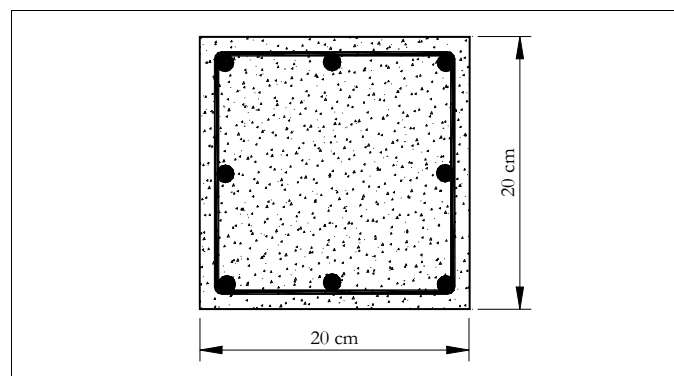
Seção e arranjo das armaduras nos pilares ensaiados por Queiroga [9].
